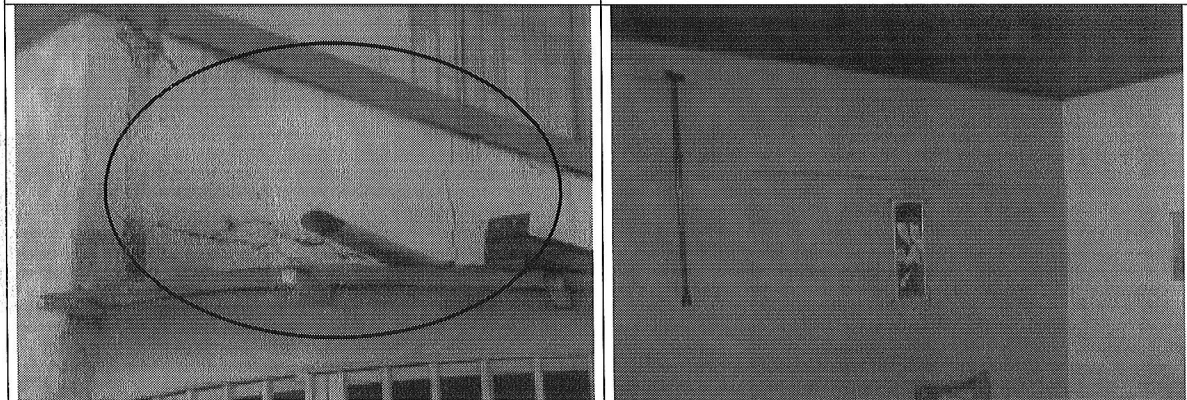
Agrietamiento en muro de fachada del costado occidental.
